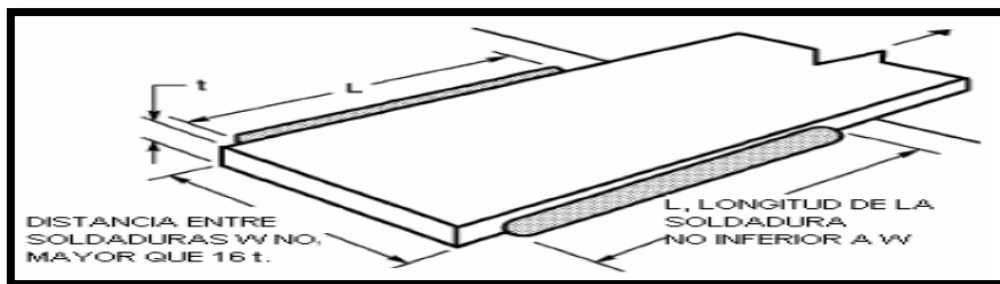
Longitud mínima de soldadura de filete en el extremo de la placa
